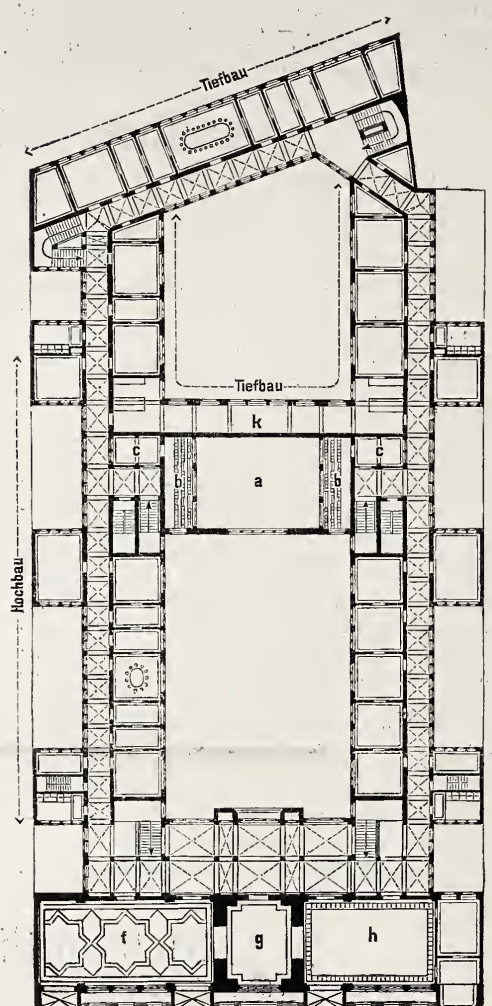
Grundriss vom 2. Obergeschoss.
